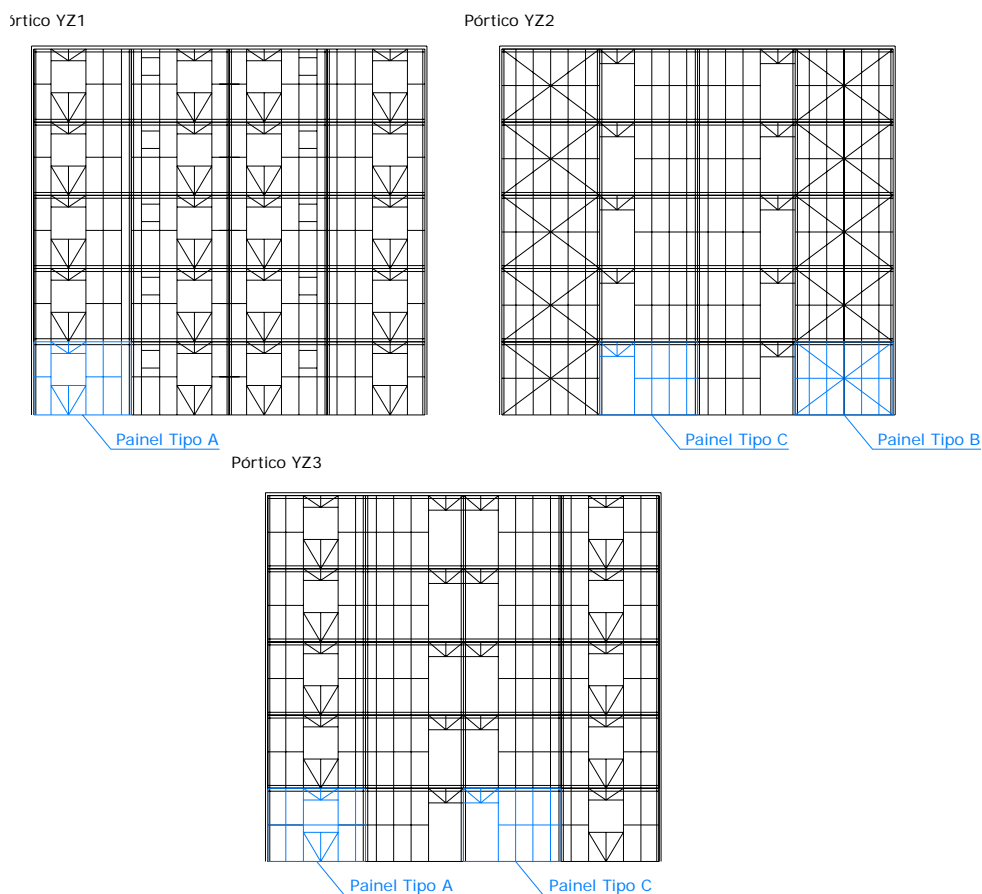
Pórticos do sistema estrutural proposto segundo a direcção y, nomeação dos painéis “steel-frame”
